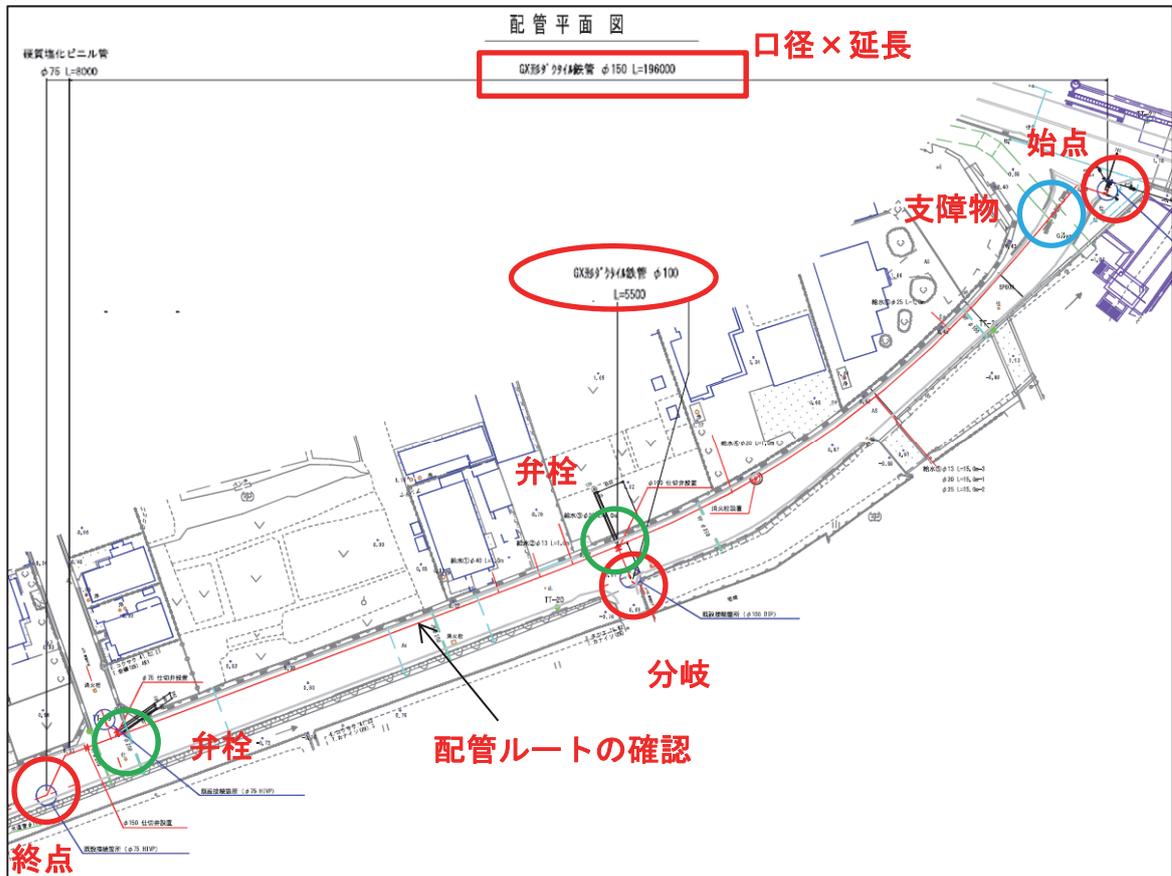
発注された設計図書（当初設計の平面図）の確認例
